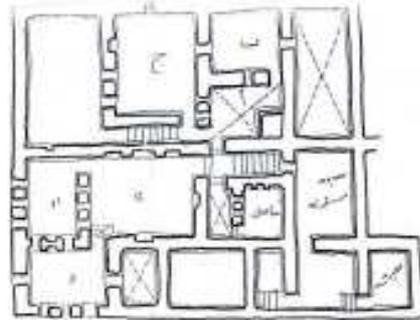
مسقط أفقي للدور الأرضي بدار ببلدة القصر
